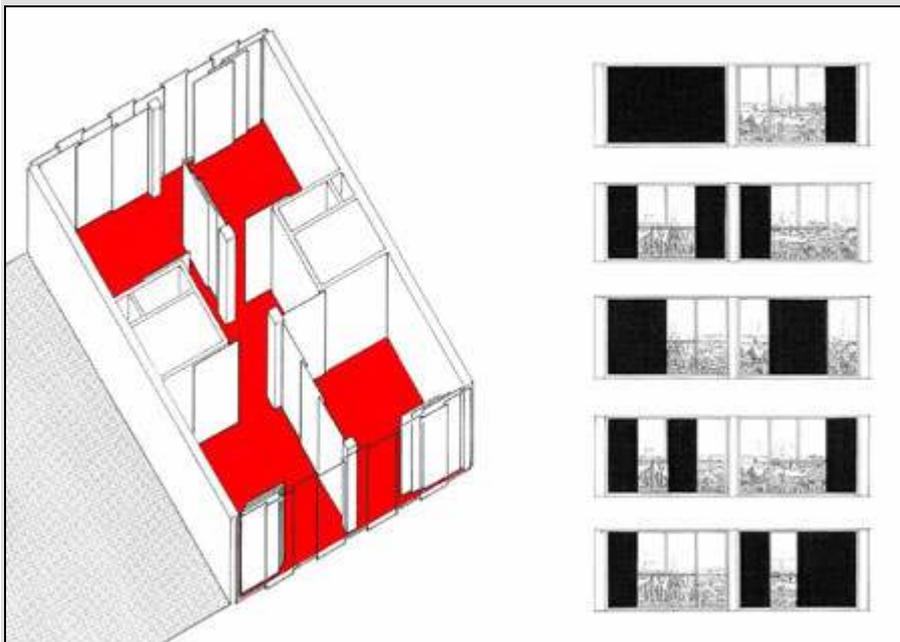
Mögliche Grundrisse im Projekt Grieshofgasse (Quelle: DI Helmut Wimmer Architekt)
